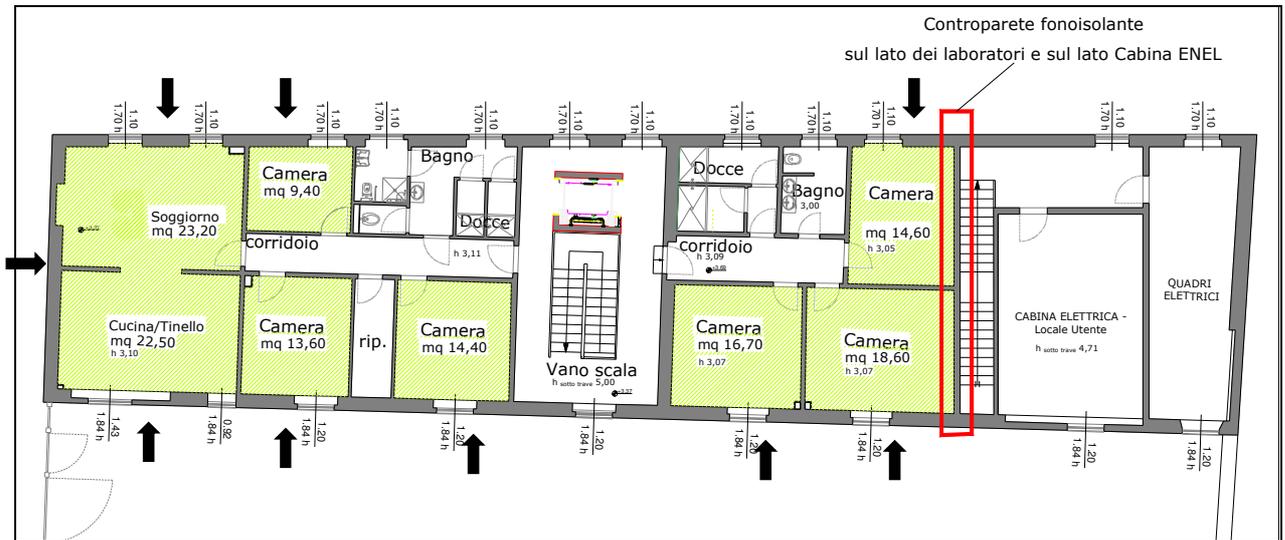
Pianta piano primo dell'edificio con indicazione degli "ambienti abitativi" oggetto di verifica
